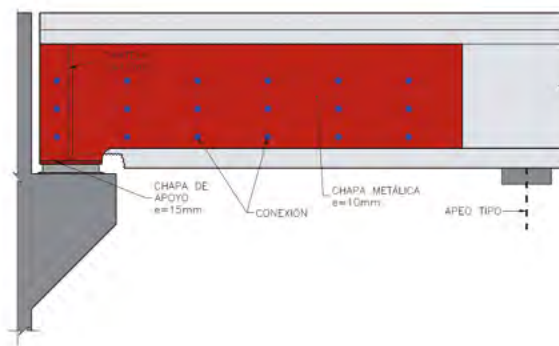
Deterioro culata de viga de hormigón pretensado y refuerzo de las mismas.
